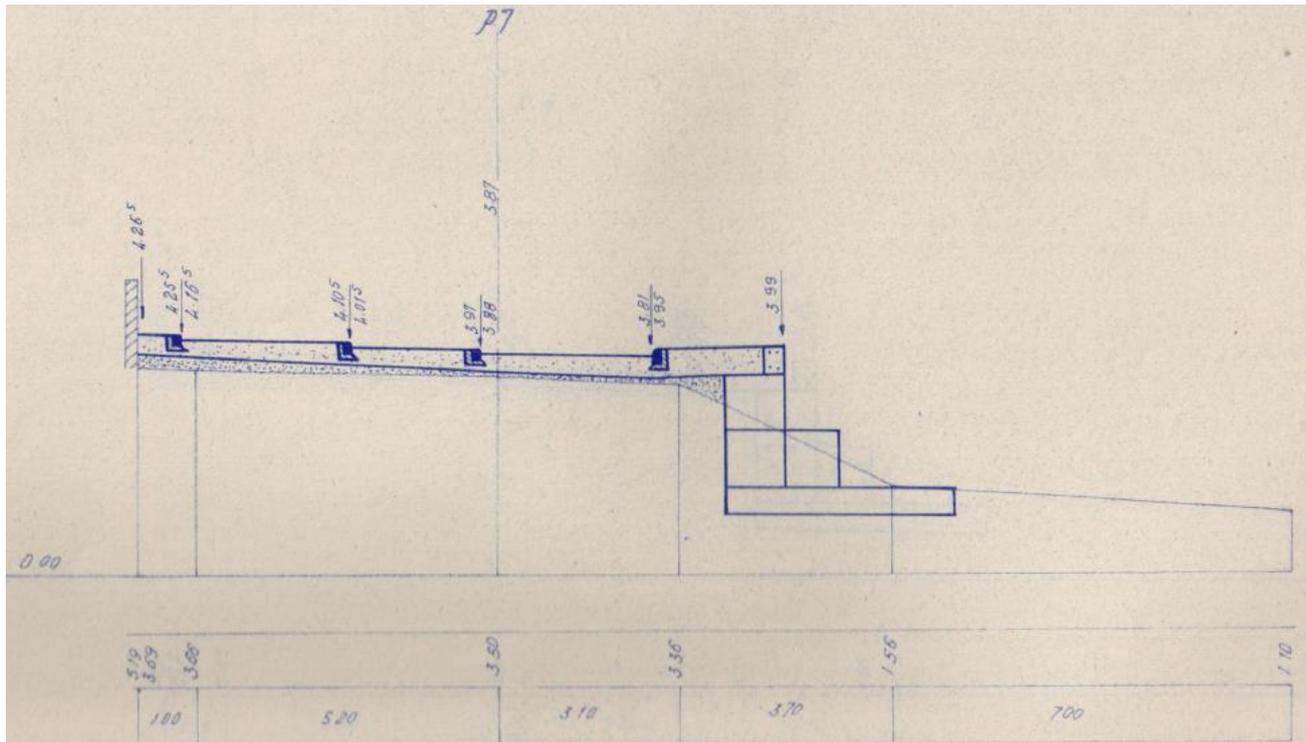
Vue en plan et coupe sur soutènement gabion 1977
